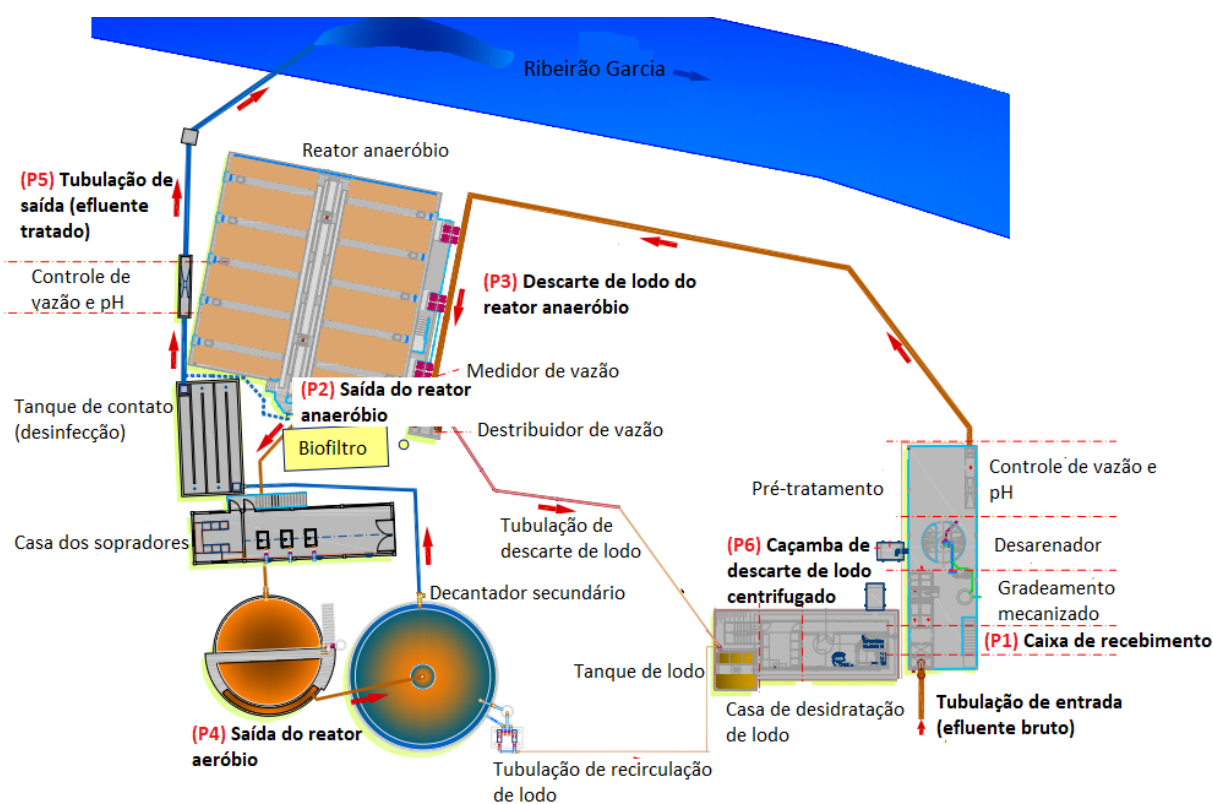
Planta baixa do sistema de tratamento de esgoto do Bairro Garcia.
